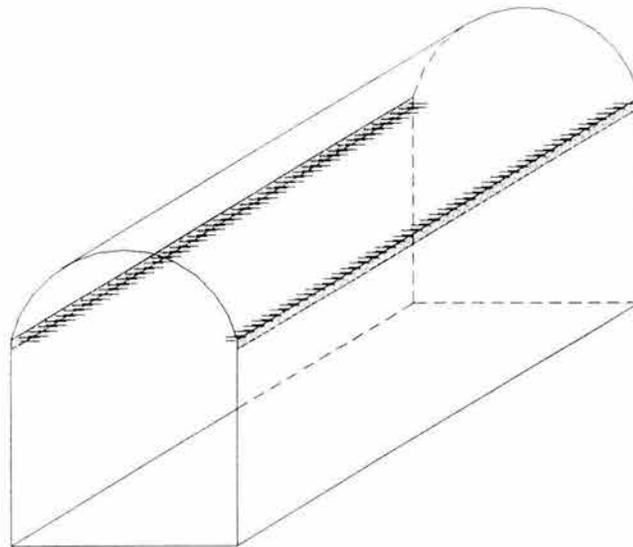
Preparaciones para el Colado de la Losa Intermedia.
